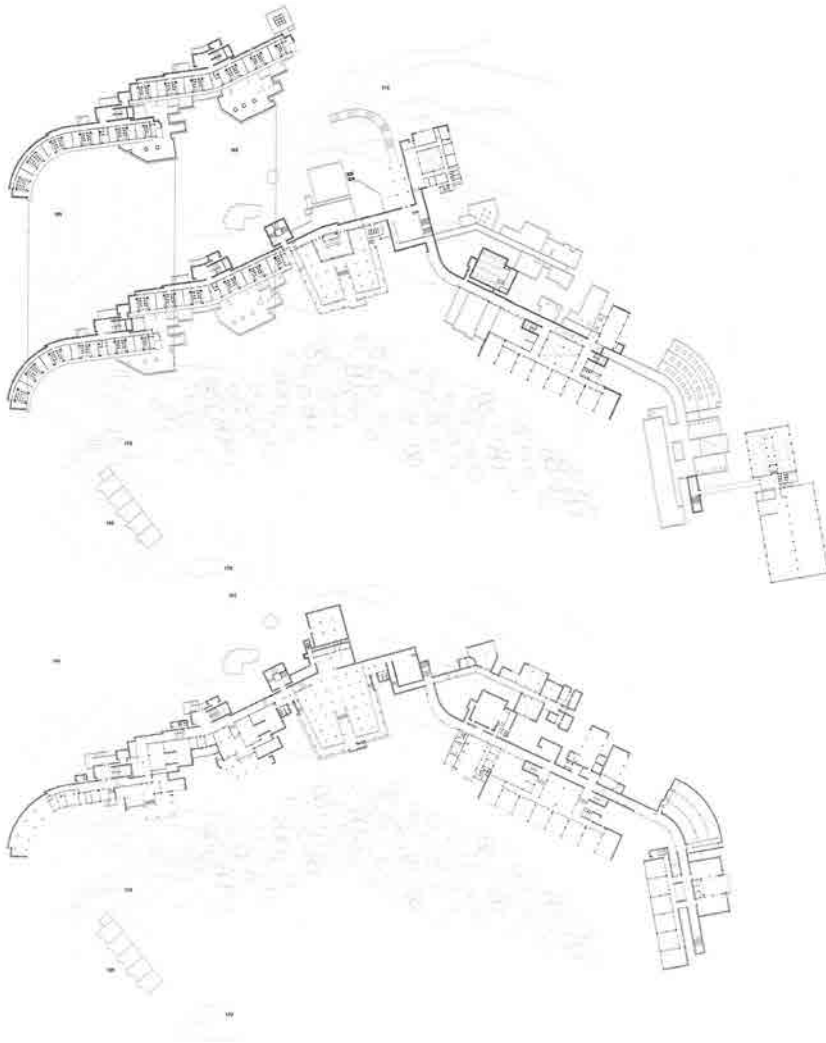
, Fig. 7 y Fig. 8 Plantas generales del conjunto. Plantas segunda y primera (arriba), planta principal o de acceso (centro) y planta baja (abajo).
